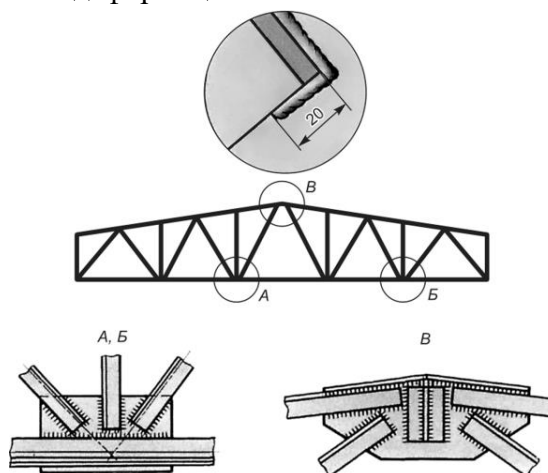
Сварка фермы и ее узлов А, Б, В
